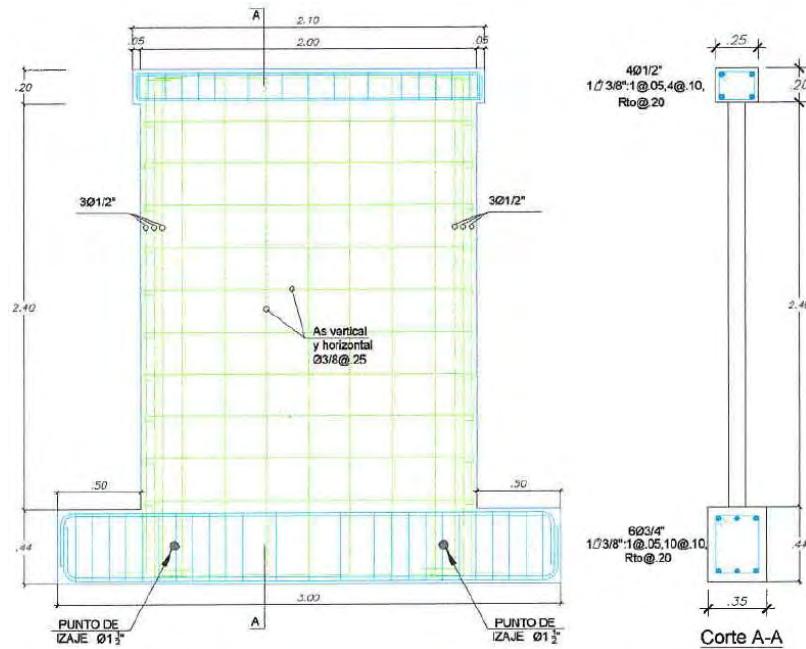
Detalle estructural de placas ensayadas (Sencico, 2016)
